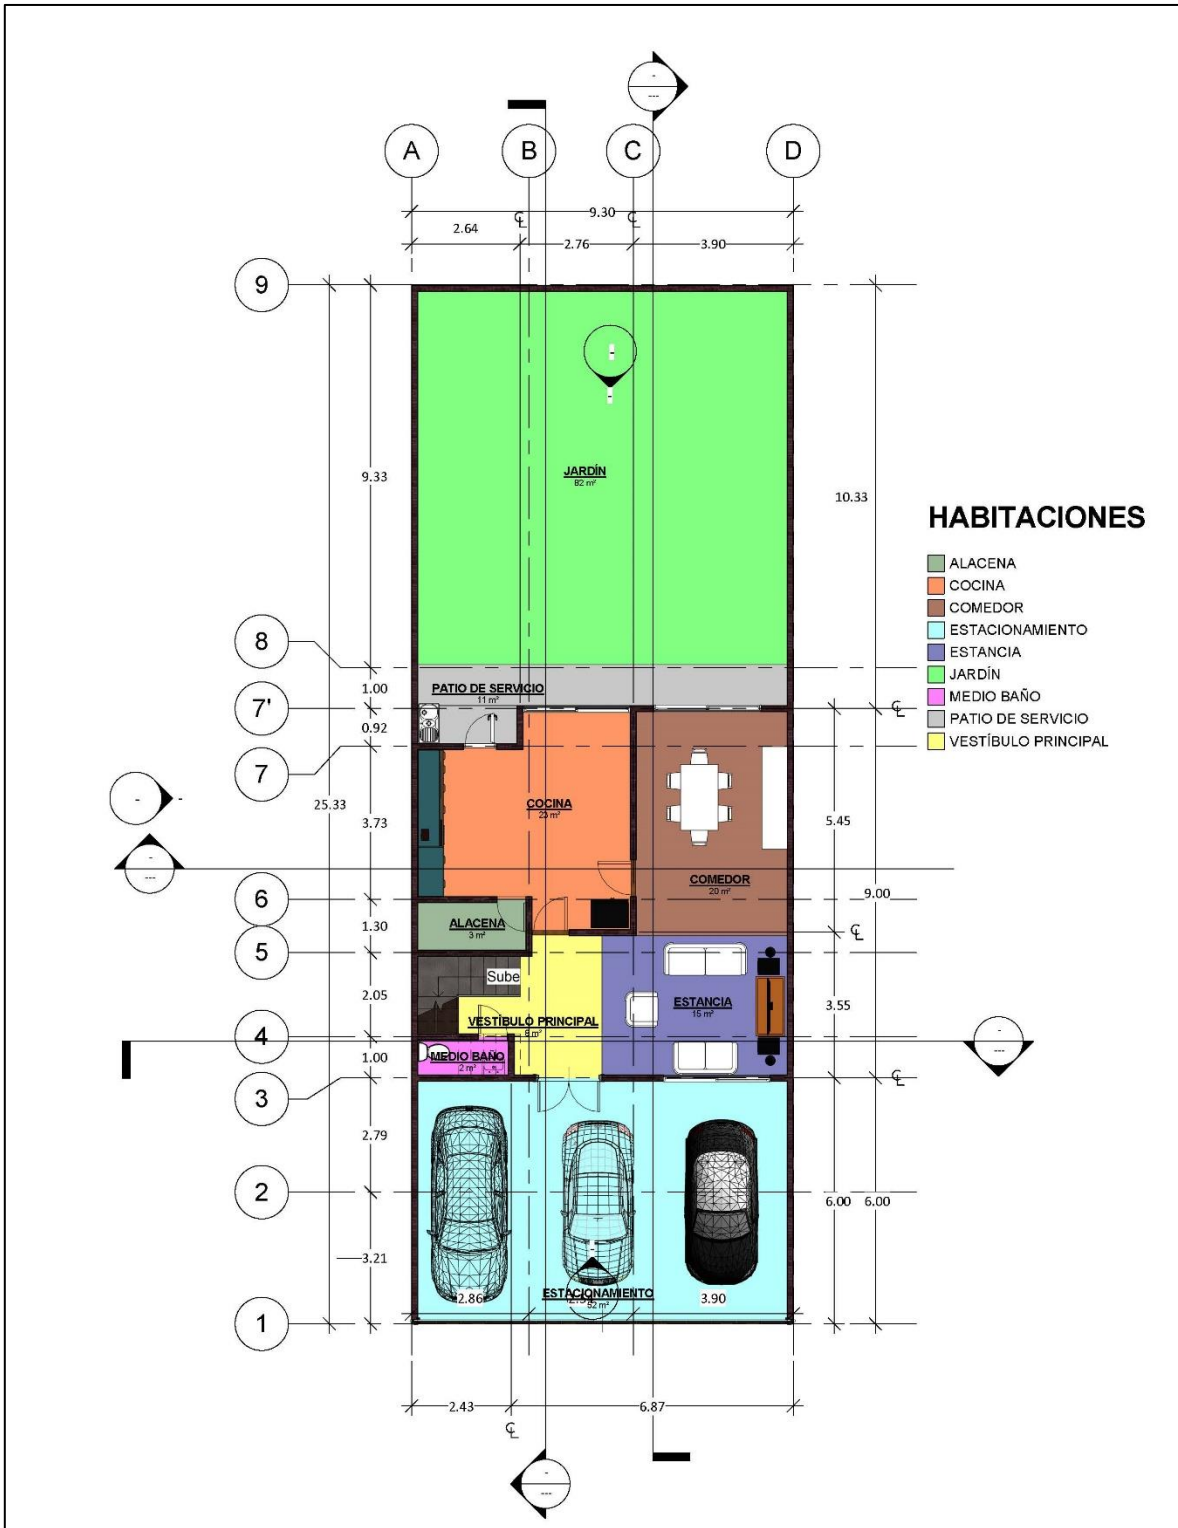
Plano de vivienda no sustentable: planta baja. Fuente: autoría propia
